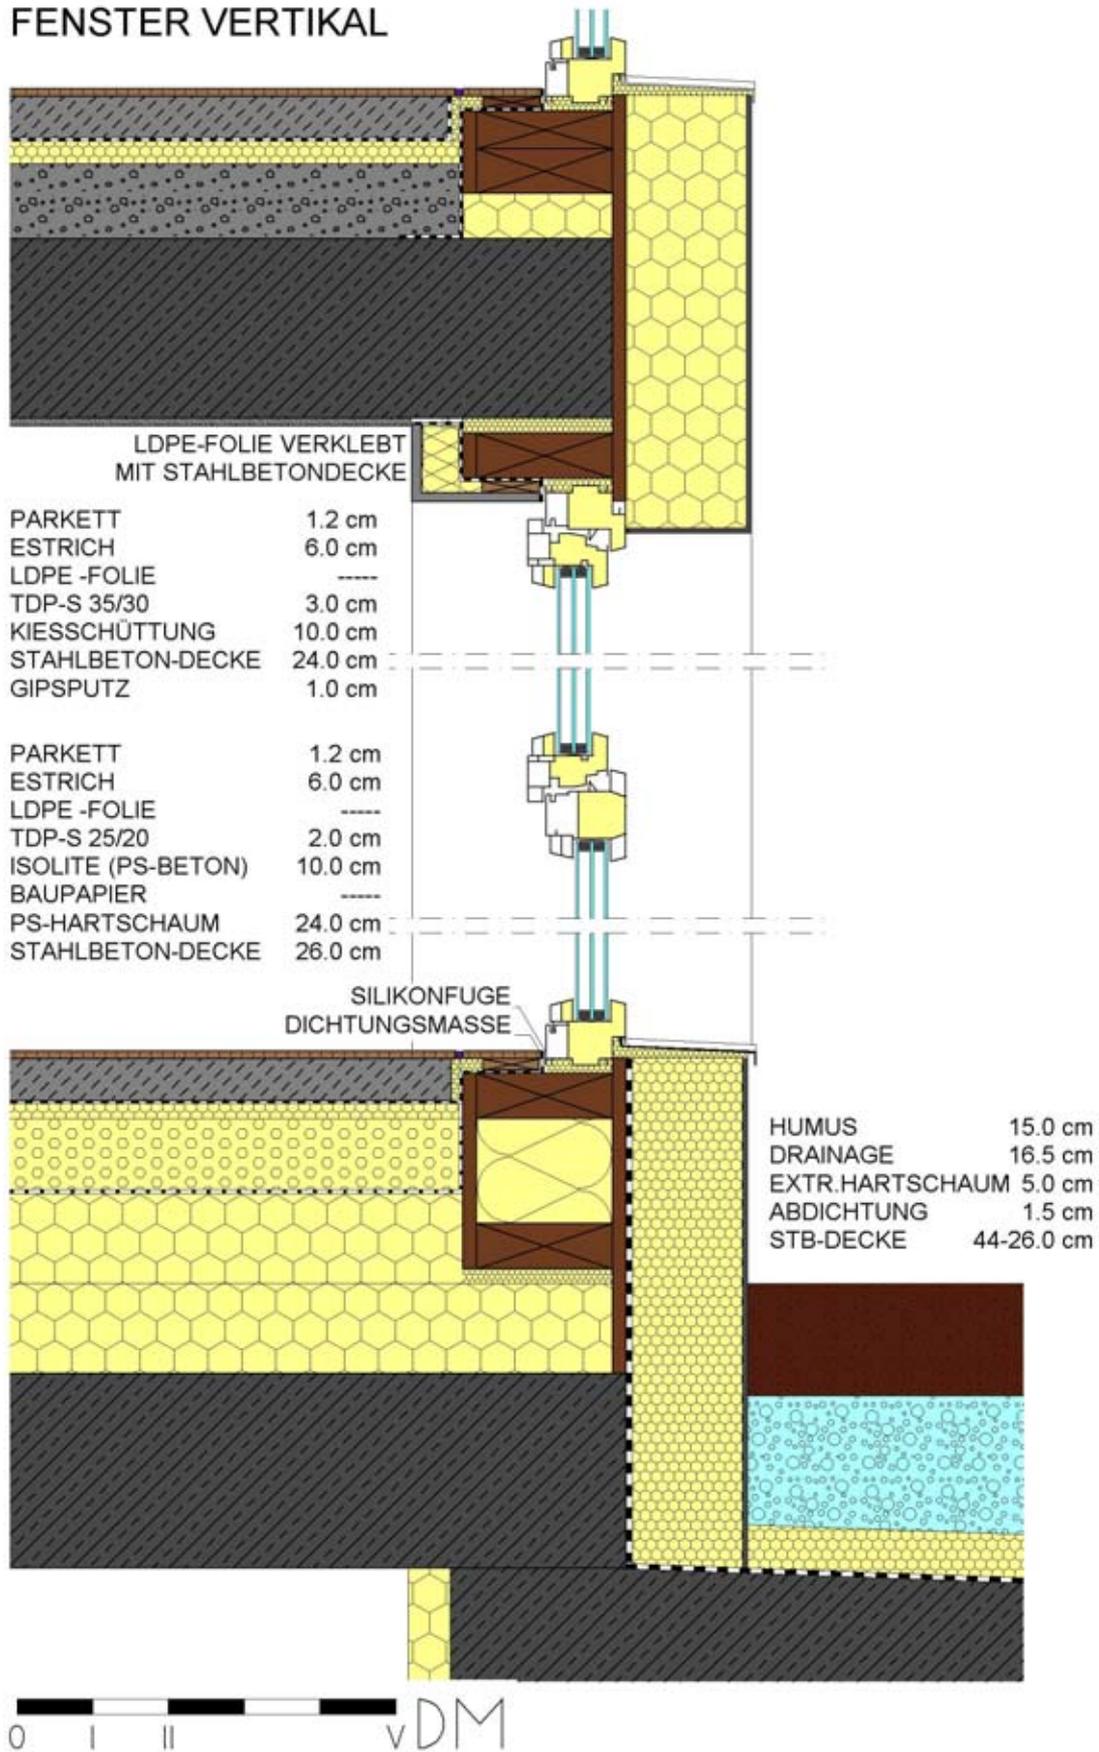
Anschluss Geschosswischendecke an Außenwand und Fensteranschluss
